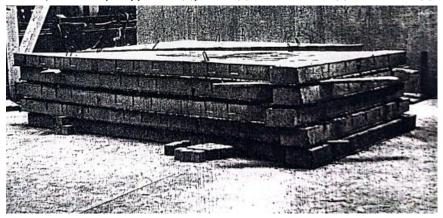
Хранение плоских треугольных плит в штабелях.
